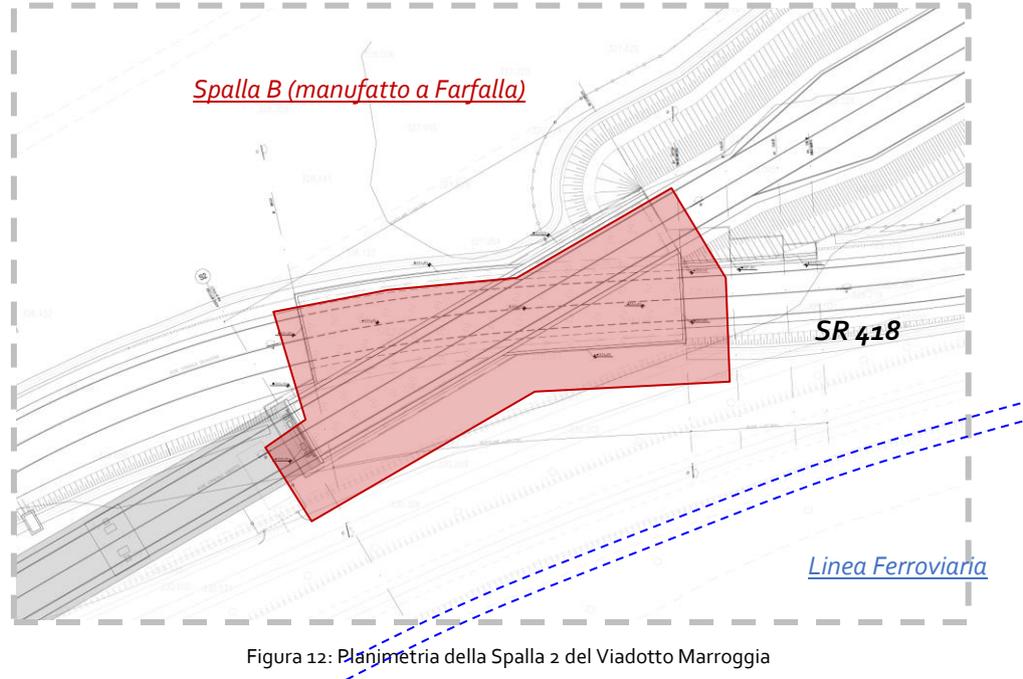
Planimetria della Spalla 2 del Viadotto Marroggia
